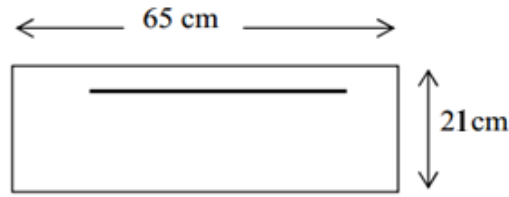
Coupe schématique de la poutrelle (travées)
